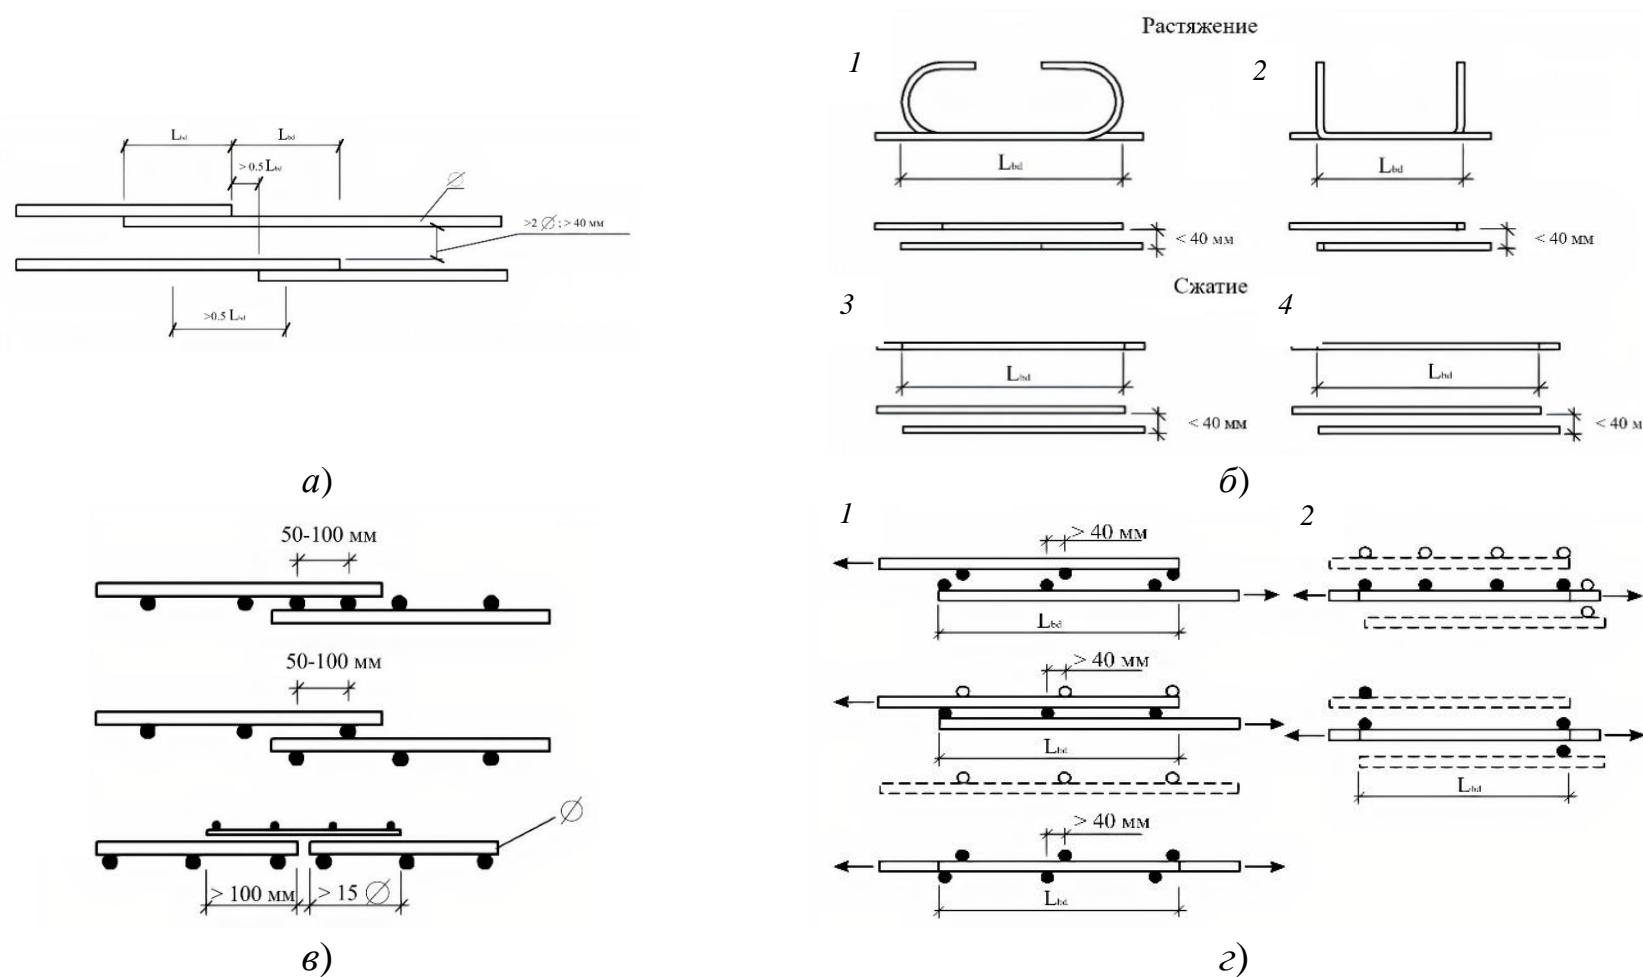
Соединение арматурных изделий перепуском (рабочий стык):
